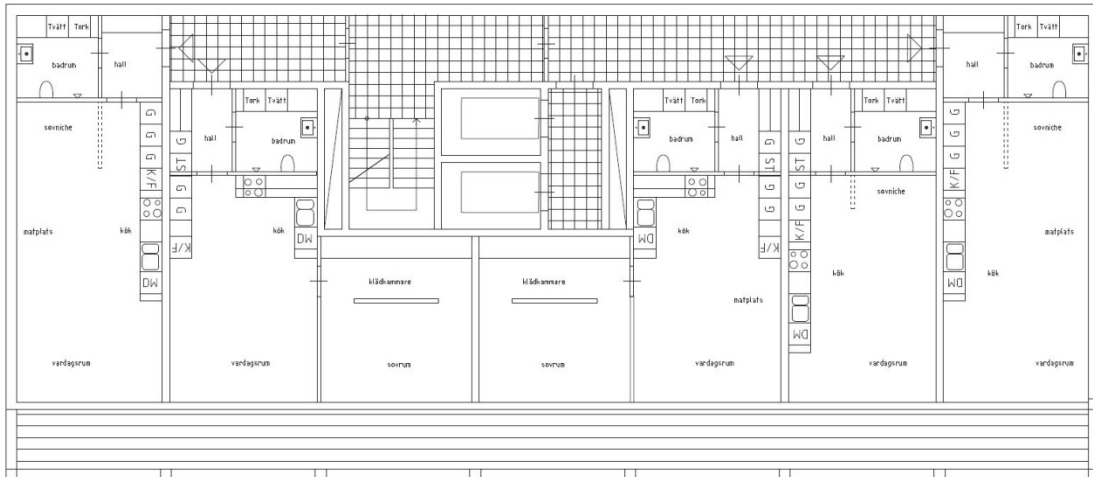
Exempel på planlösningar för byggnaderna ovanför centrumbyggnaden.
